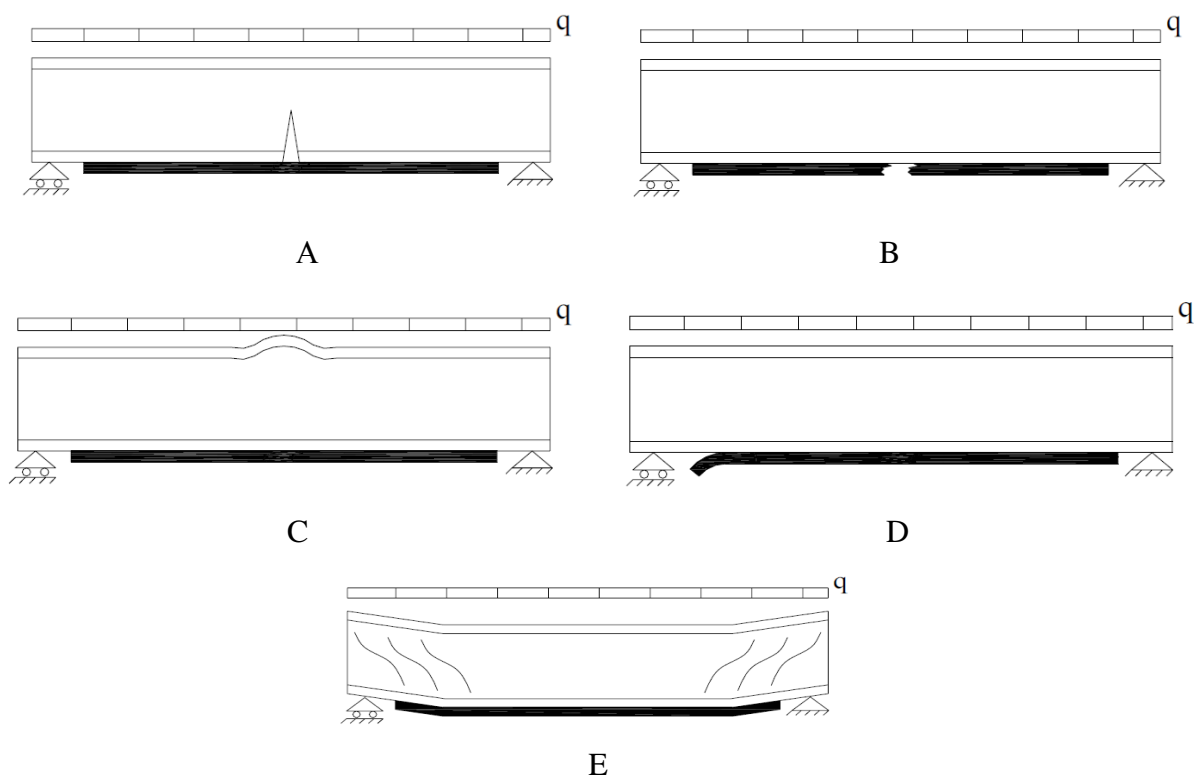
Схемы разрушения изгибаемой металлической балки, усиленной ФАП. А) разрушение от растяжения в усиливаемой балке; В) разрушение от растяжения ФАП; С) местное выпучивание усиливаемой балки; D) отслоение ФАП; E) разрушение от сдвига
